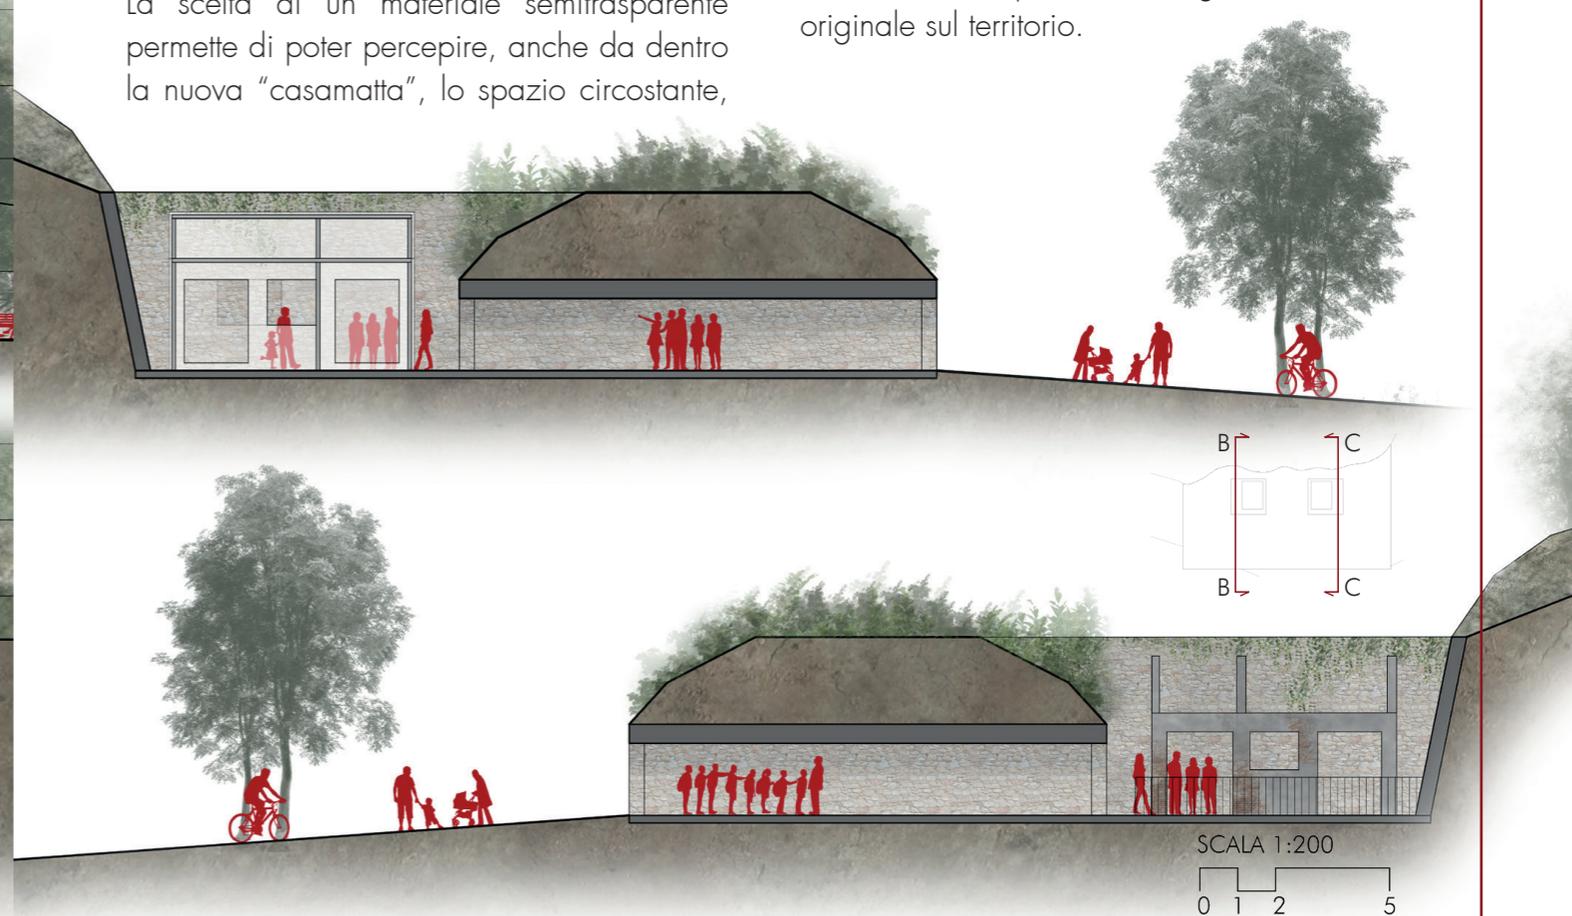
Sezione BB e sezione CC delle "casematte", elaborazione delle autrici
